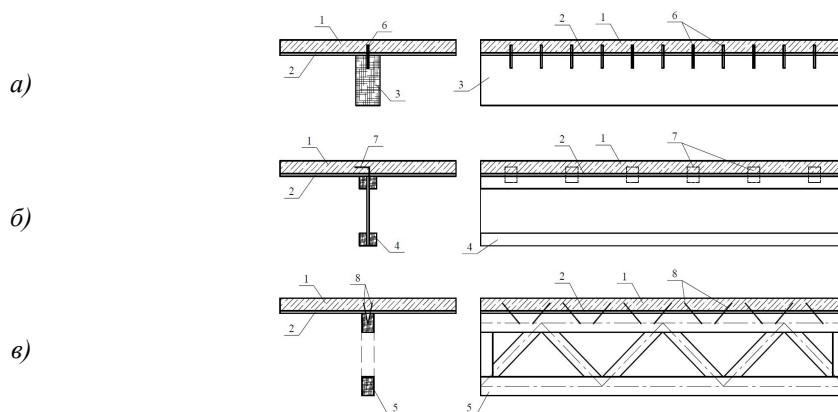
Варіанти конструкцій другорядних деревобетонних балок: а) з балками суцільного перерізу; б) з балками складеного перерізу; в) з фермами на металевих зубчастих пластинах; 1 – залізобетонна або армувана ґрунтобетонна плита; 2 – незнімна опалубка; 3 – клеєний дерев'яний брус; 4 – двотаврова балка складеного перерізу; 5 – ферма; 6 – механічні в'язі нагельного типу; 7 – металеві зубчасті пластини; 8 – шурупи або цвяхи під кутом
